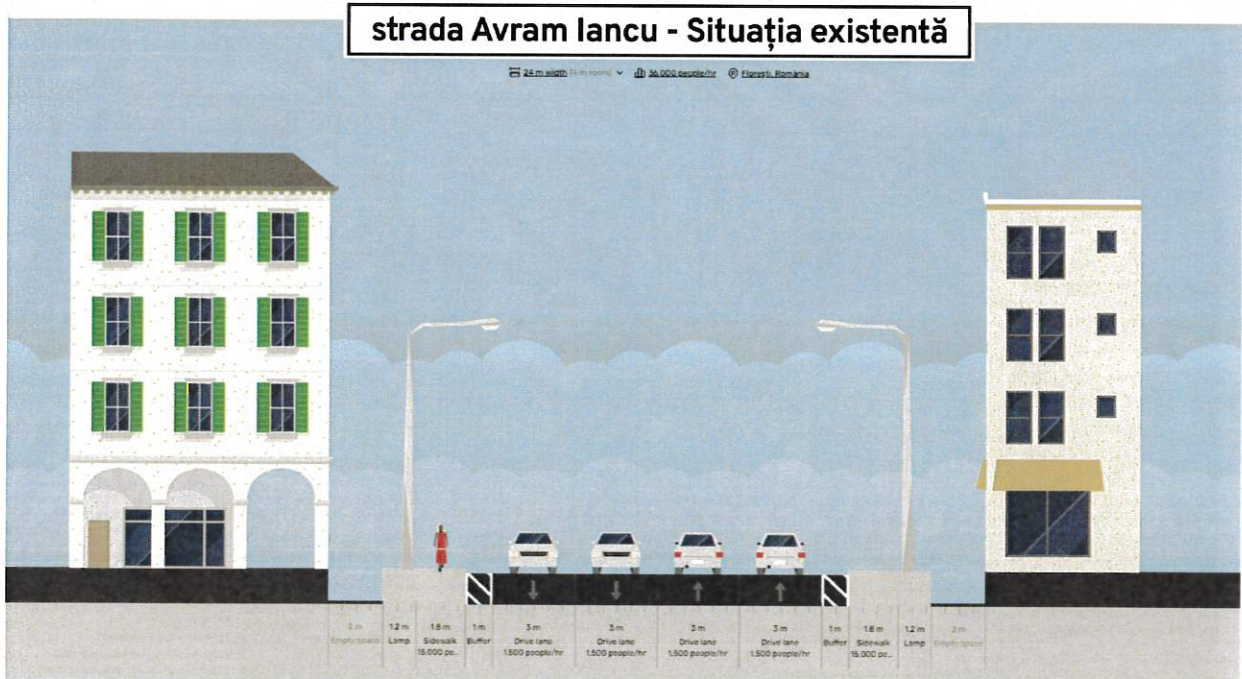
Profil transversal tip - Str. Avram Iancu situație existentă
